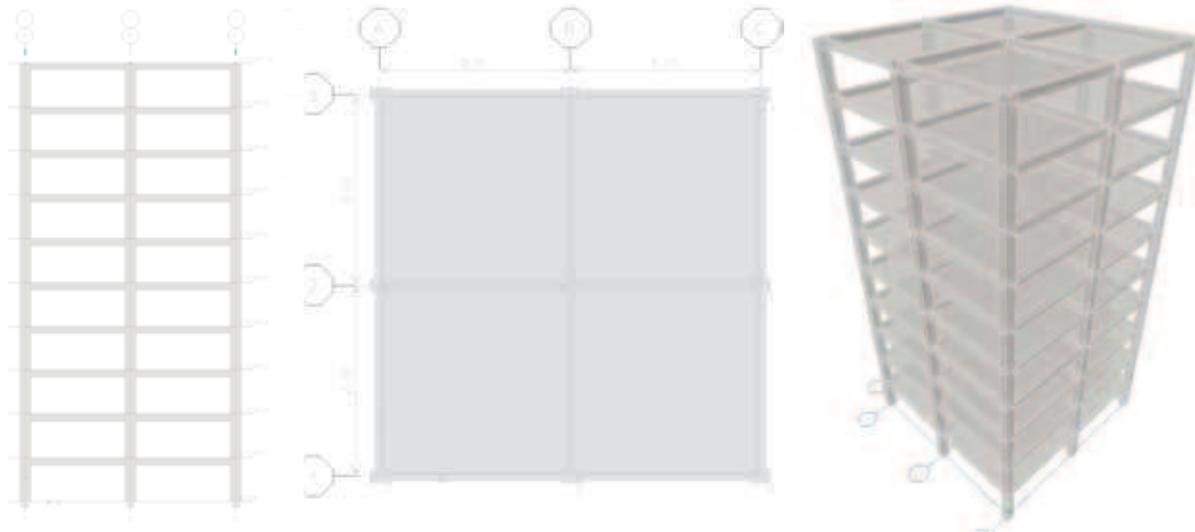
VISTA 3D EDIFICIO DE 10 PISOS, ELEVACIÓN, Y PLANTA
